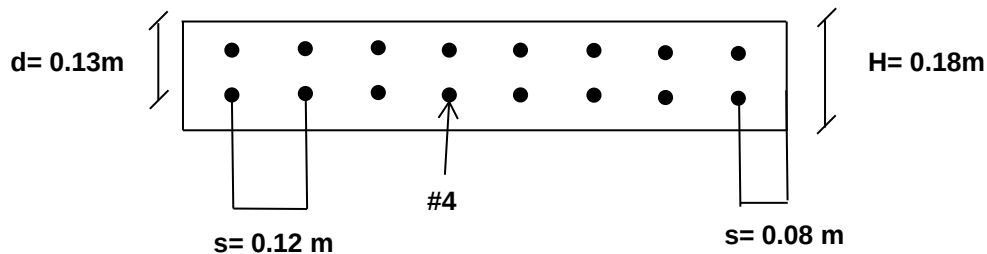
Sección longitudinal de 1 metro de la losa y su barra de refuerzo.
